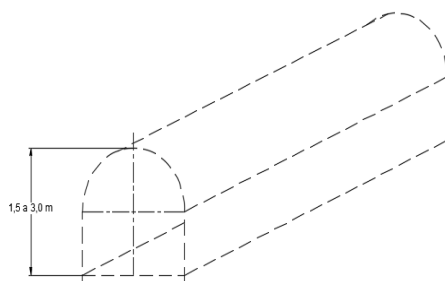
Dimensiones típicas de las galerías de inyección.
